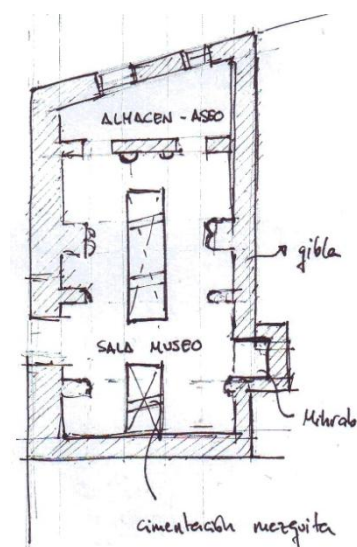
Croquis de la planta del proyecto de 1979 de Pedro San Martín.
